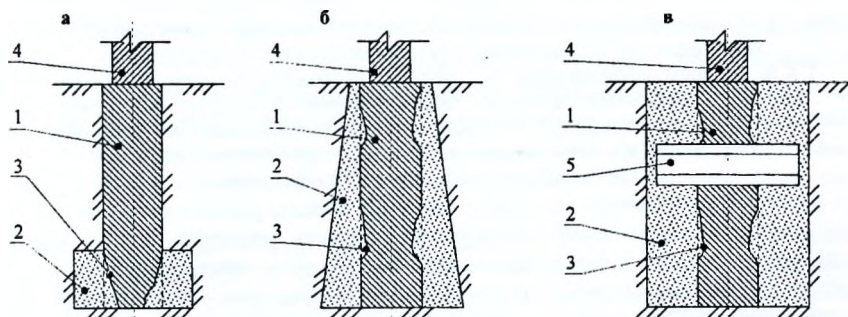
Усиление фундаментов с помощью обойм в подошве фундамента (а), по всей высоте (б), поперечный балок (в):
